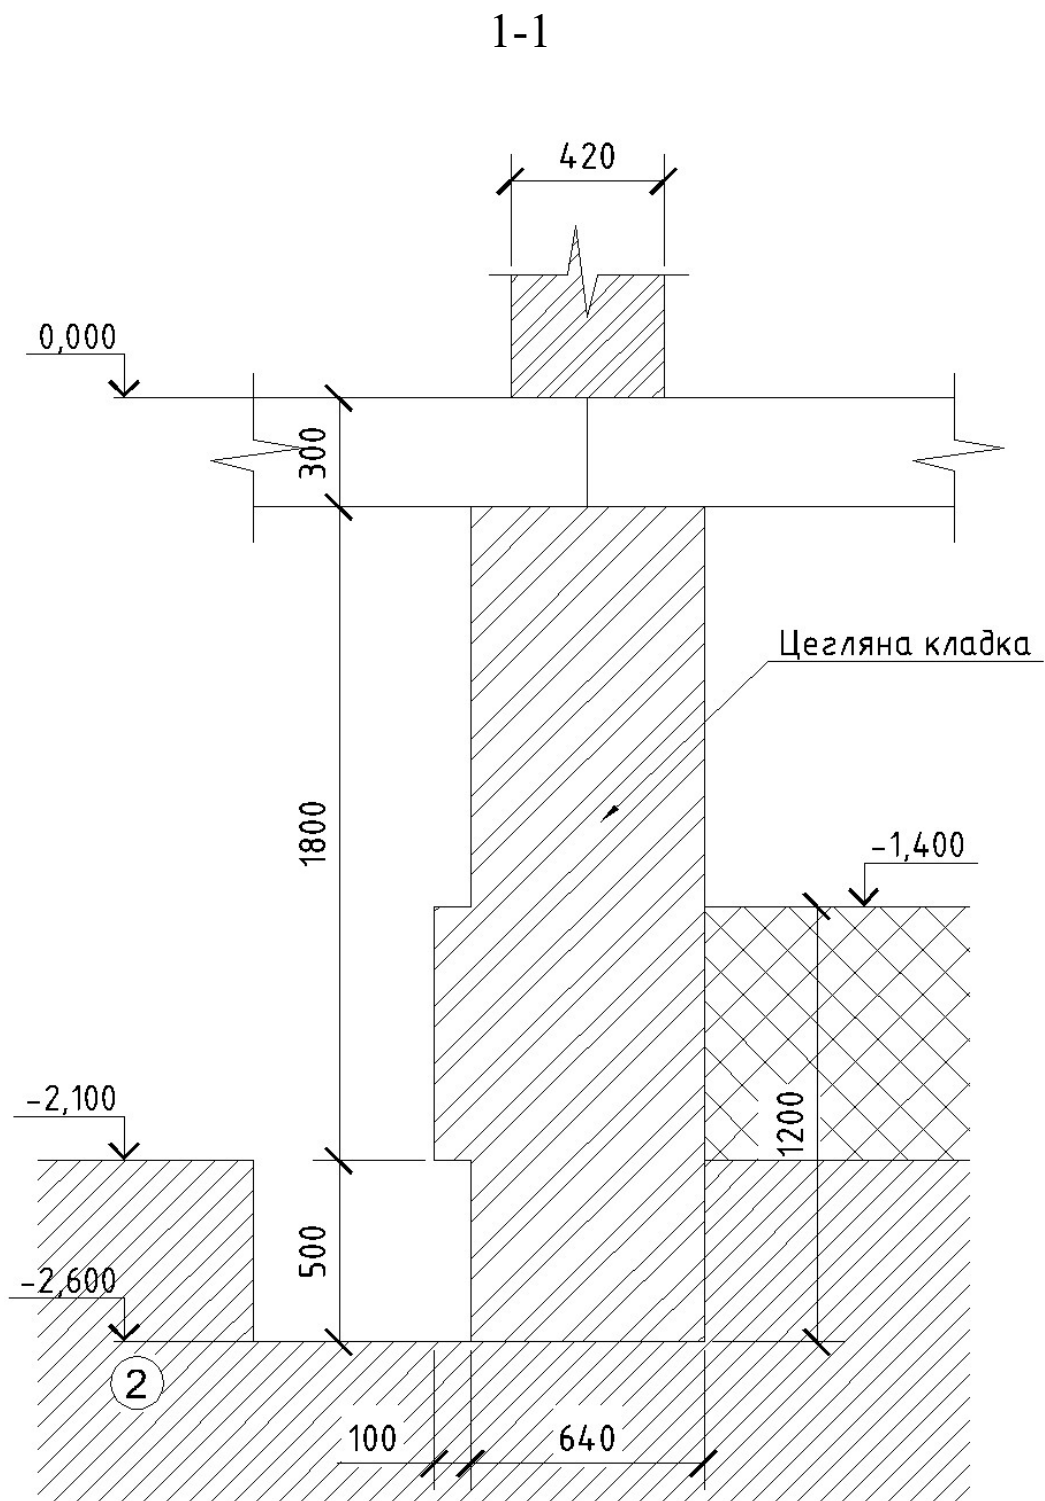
Переріз фундаментів внутрішніх поздовжніх стін
